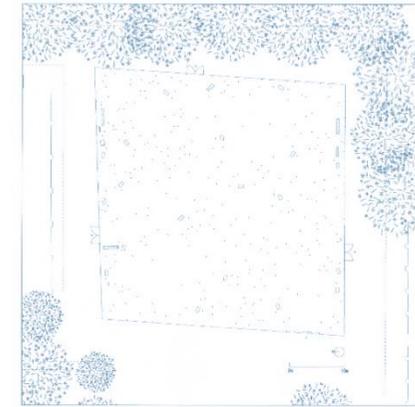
Planta donde se observan el bosque de columnas que componen el KAIT workshop.
